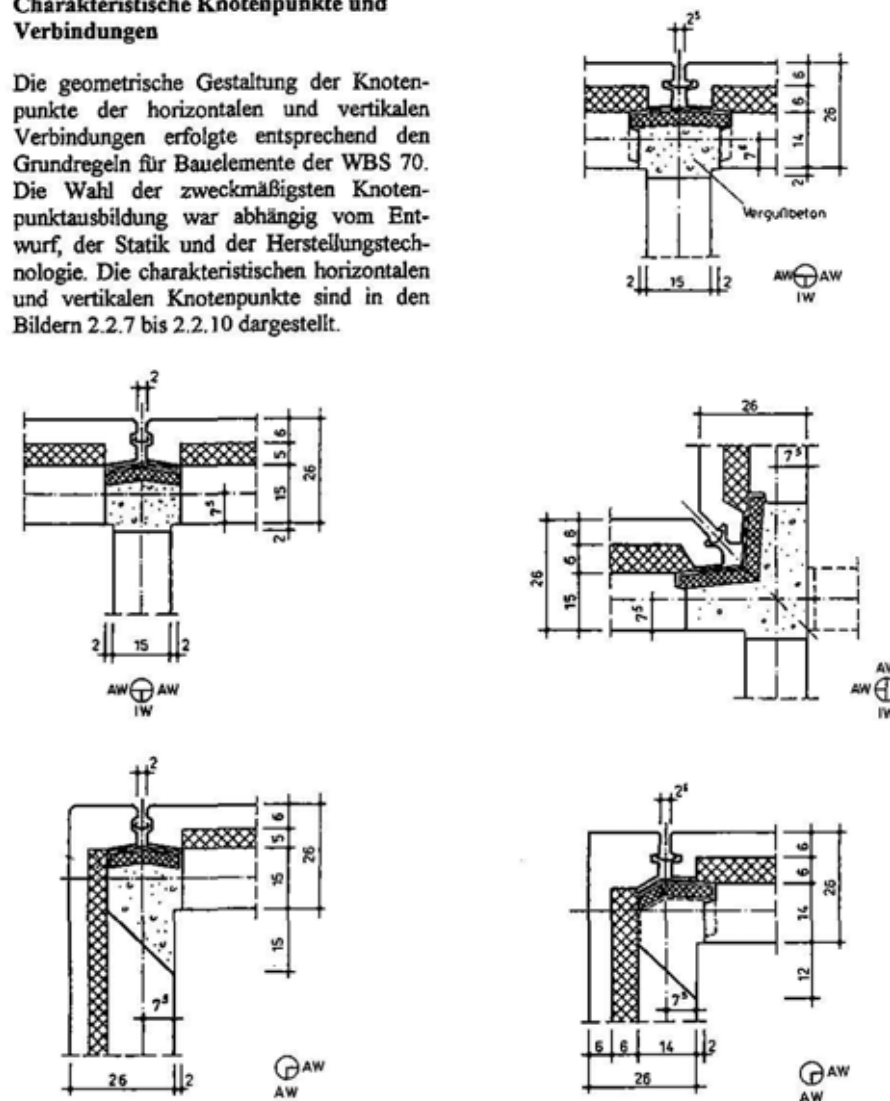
Verbindungen (Decken, Decke - AW)
